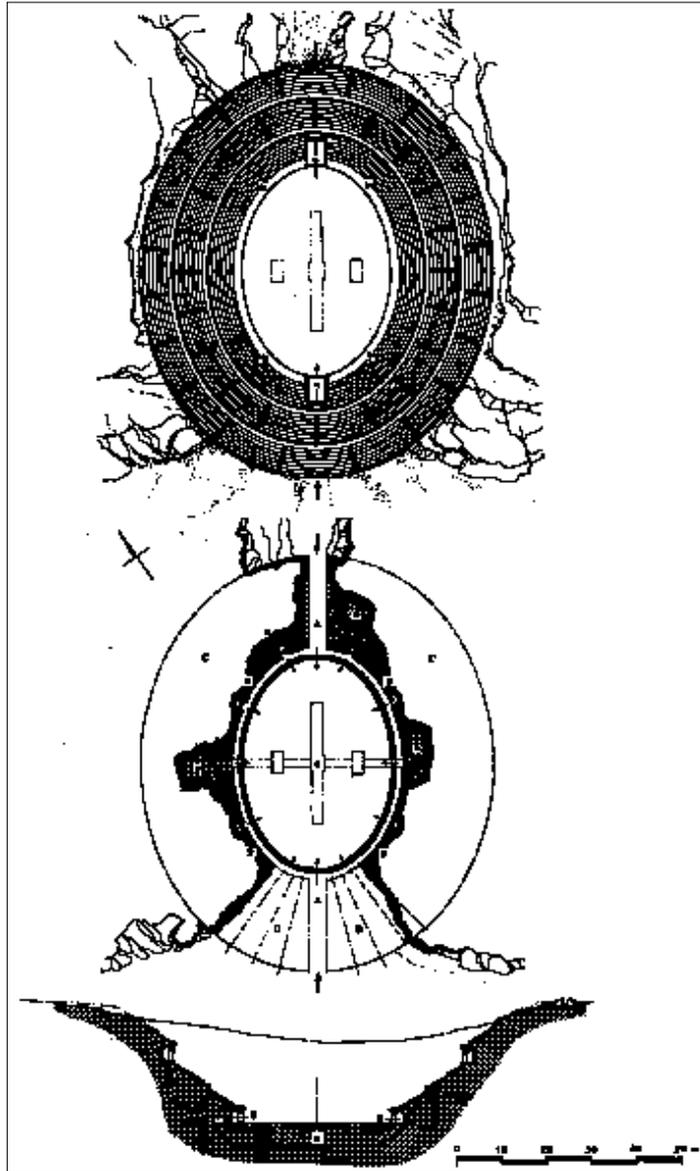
Cagliari. Ricostruzione planimetrica, pianta delle strutture ipogee e sezione Nord-Ovest/Sud-Est dell'anfiteatro (da GOLVIN 1988).
